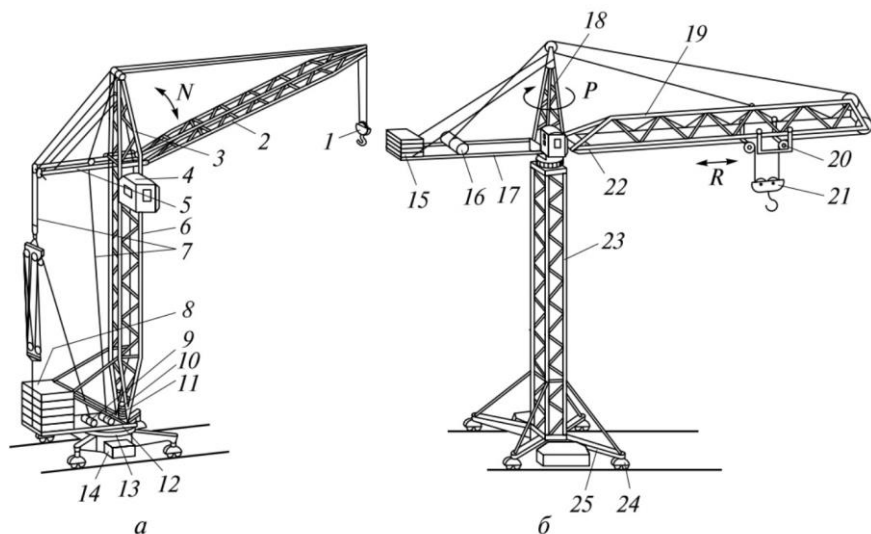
Устройство башенного крана: а) Башенный кран с подъемной стрелой и поворачивающейся башней; б) Башенный кран с балочной стрелой и неповорачивающейся башней; 1 – крюковая подвеска; 2 – стрела; 3 – оголовок; 4 – кабина; 5 – распорка; 6 – башня; 7 – стреловой полиспаст; 8 – противовес; 9 – стреловая лебедка; 10 – грузовая лебедка; 11 – механизм поворота; 12 – поворотная платформа; 13 – опорно-поворотное устройство; 14 – балласт; 15 – ходовая рама; 16 – ходовая тележка; 17 – грузовая тележка; 18 – лебедка для изменения вылета; 19 – противовесная консоль
